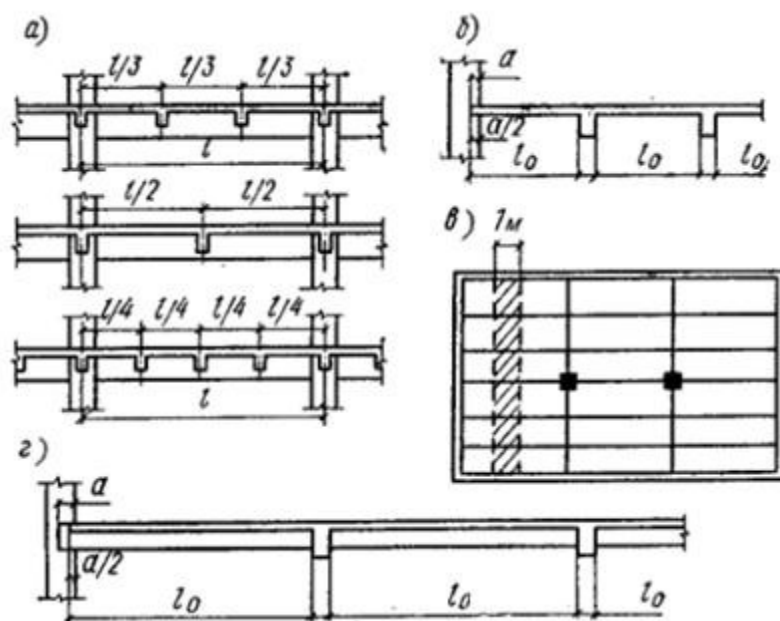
Схемы балок и плит ребристых перекрытий
